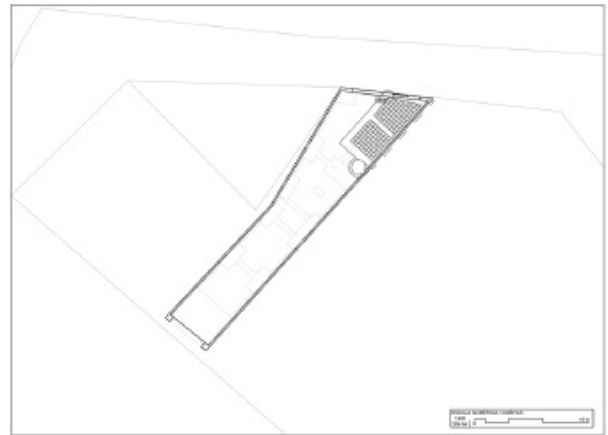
Planta de l'emplaçament dels dipòsits a l'extrem NE de l'edifici.
